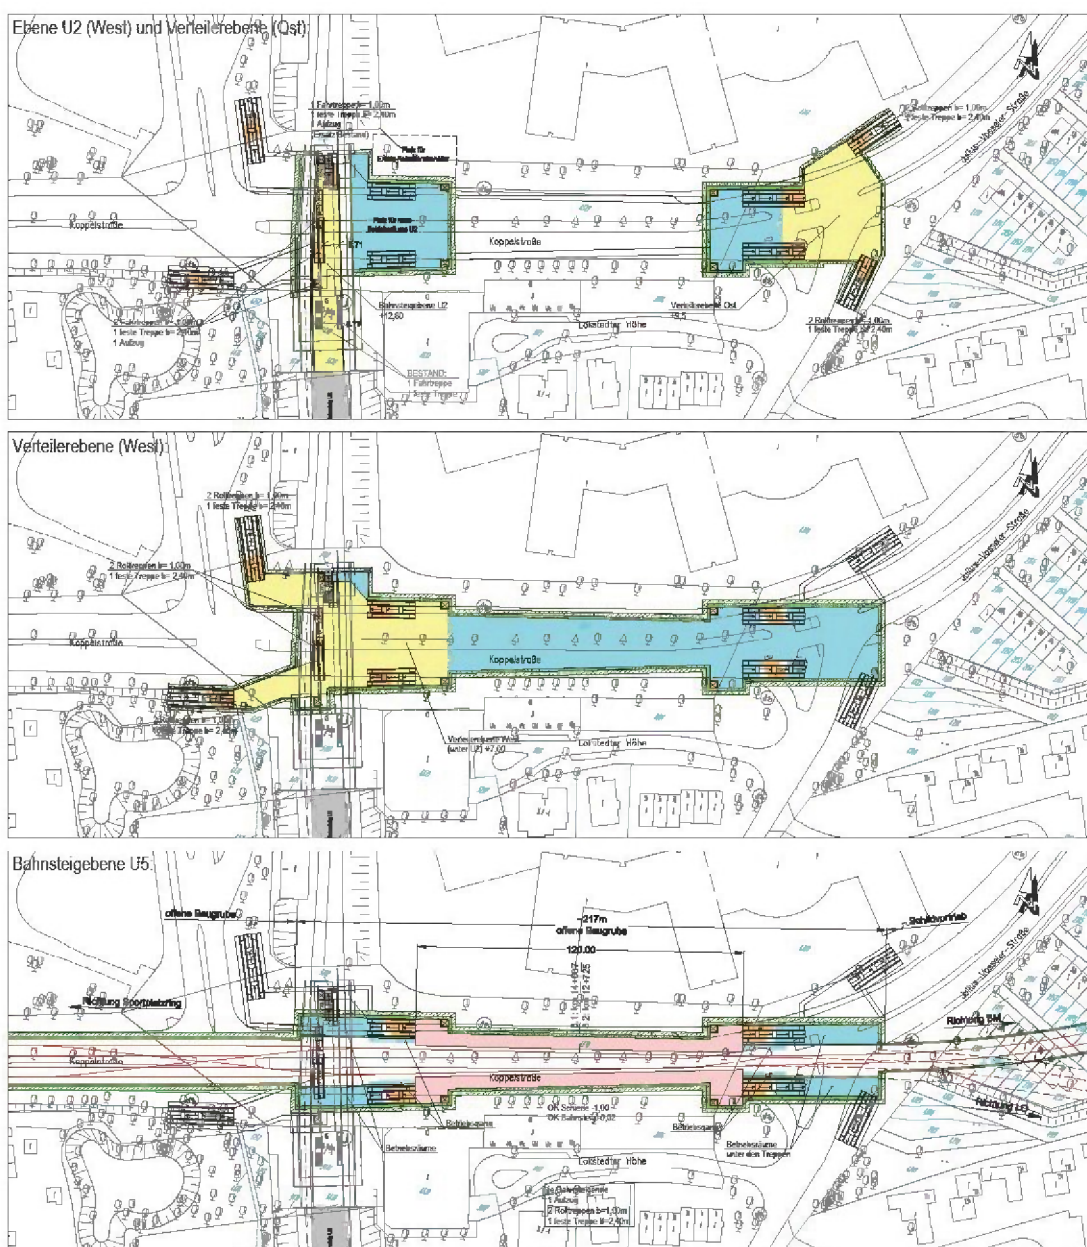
Lageplan Haltestelle Hagenbecks Tierpark I
